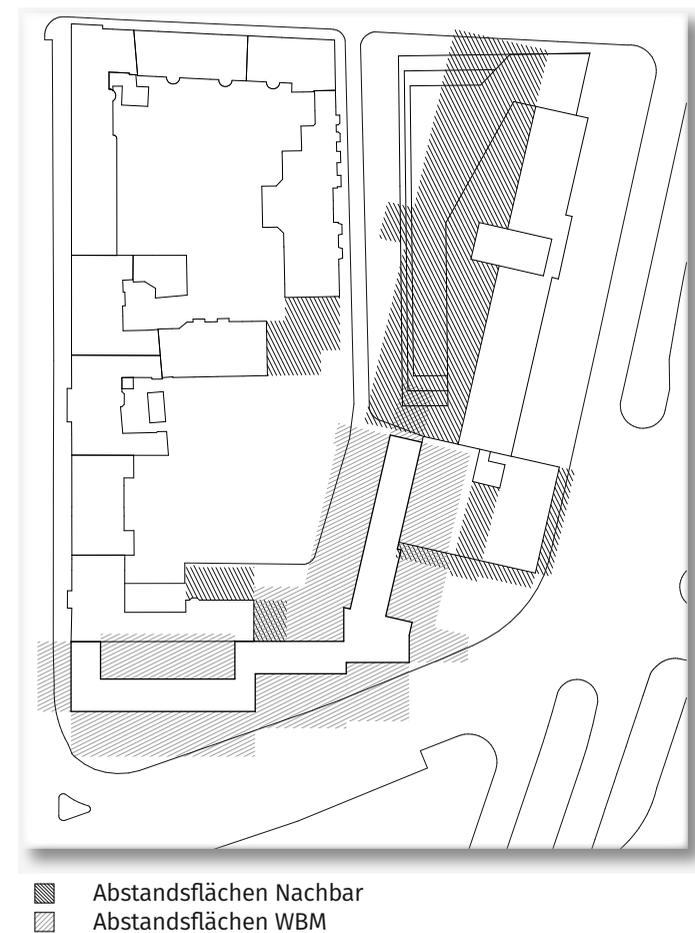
Lageplan. Abstandsflächen M 1 : 500
